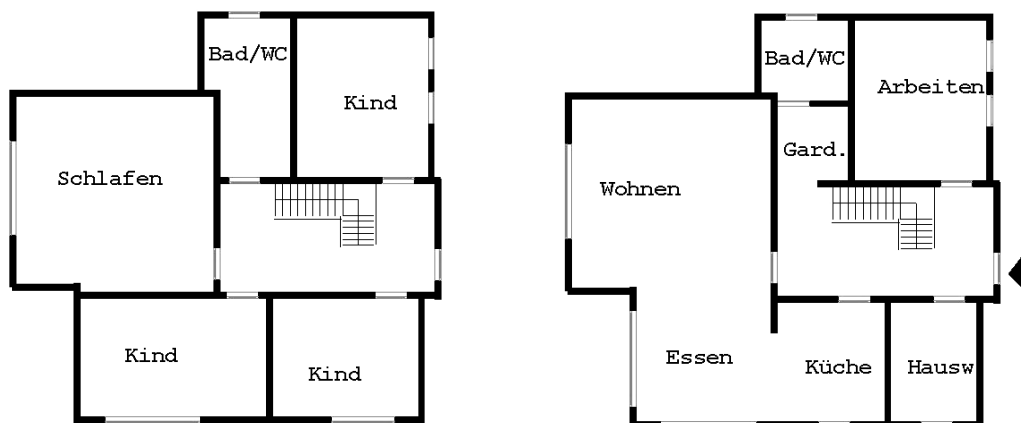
Grundrissbeispiel Einfamilienhaus EG/OG, „individueller Typ“ mit großem Wohnraum und zentralem, offenem Treppenhaus, Baujahr 1972, Überzeichnungen im Internet veröffentlichter Immobilienangebote, ohne Maßstab
